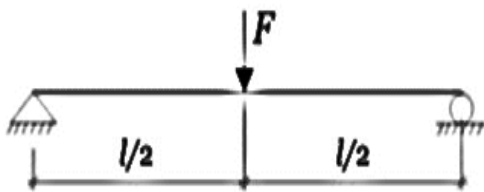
Схема навантаження СЕ моделі залізобетонного ригеля
